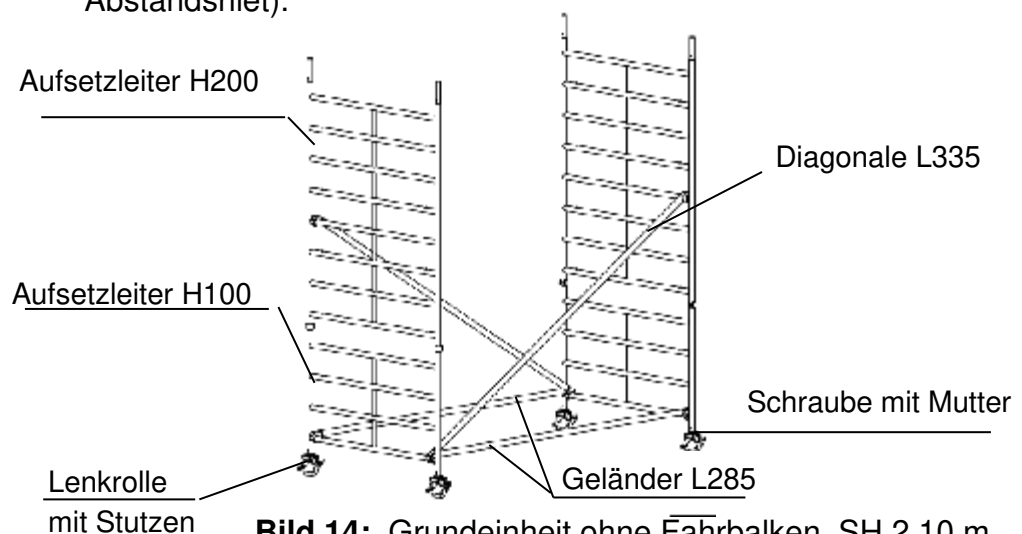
Grundeinheit ohne Fahrbalken, SH 2.10 m
